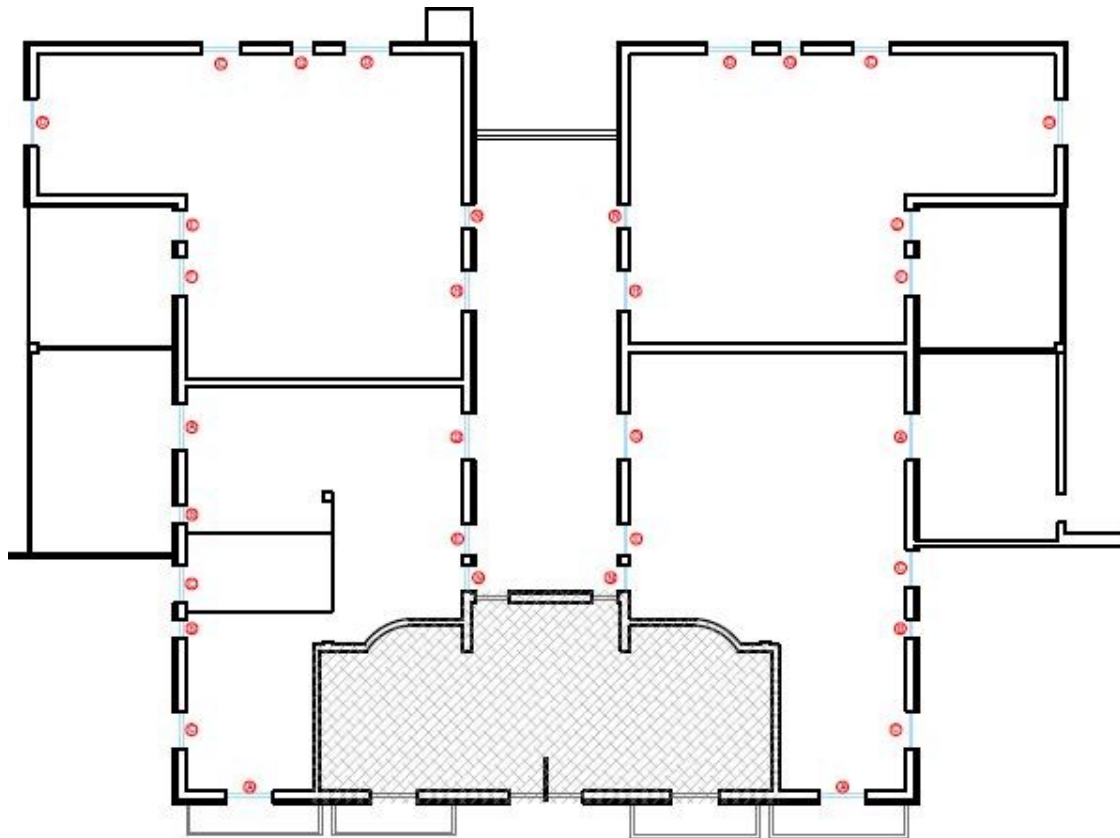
Planimetria infissi da sostituire allegata all'abaco 1
